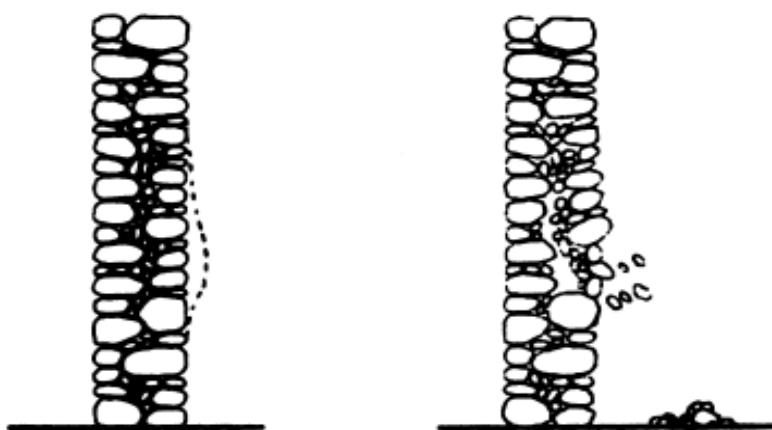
Deformação e colapso de um dos panos exteriores de uma parede de alvenaria de pedra [10]
